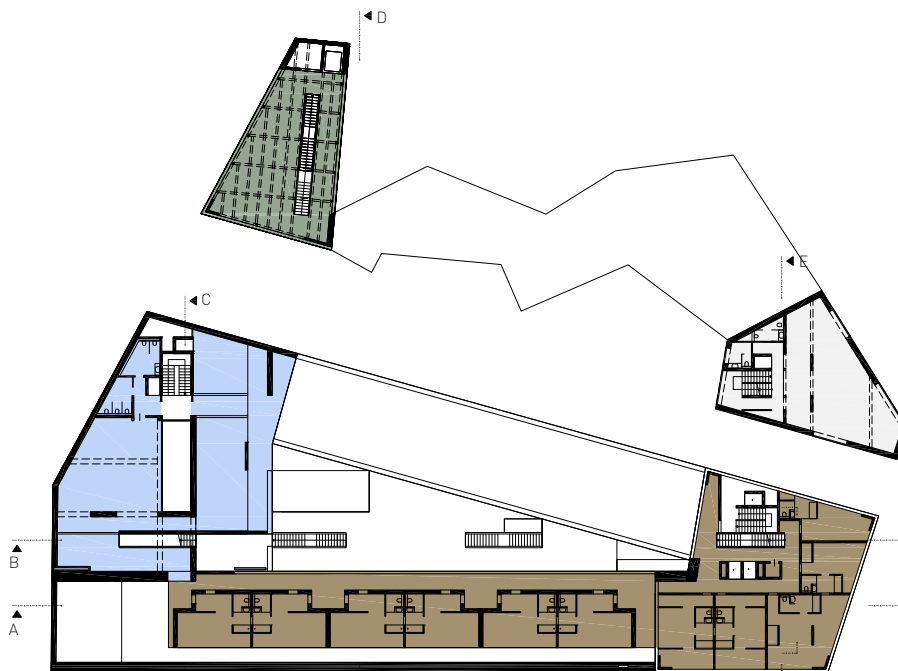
Grundriss Funktionen 3.OG +16,09m
